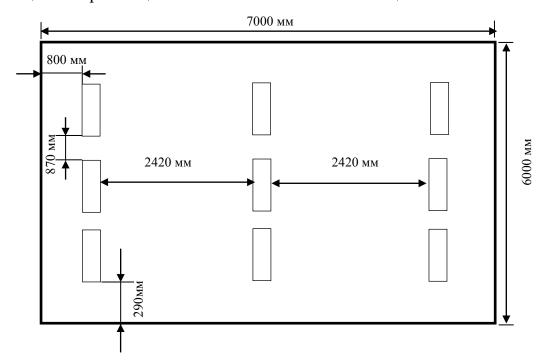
План помещения и размещения светильников с люминесцентными лампами
